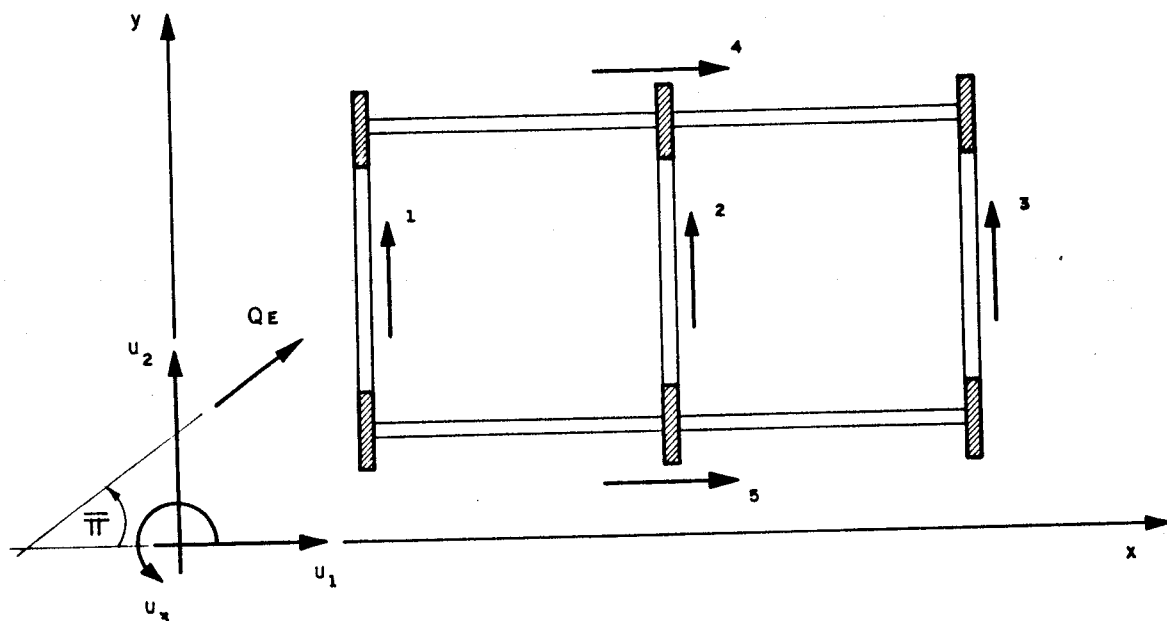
Planta da estrutura do edifício da FIG. 4.20, na qual as setas numeradas identificam às unidades estruturais
